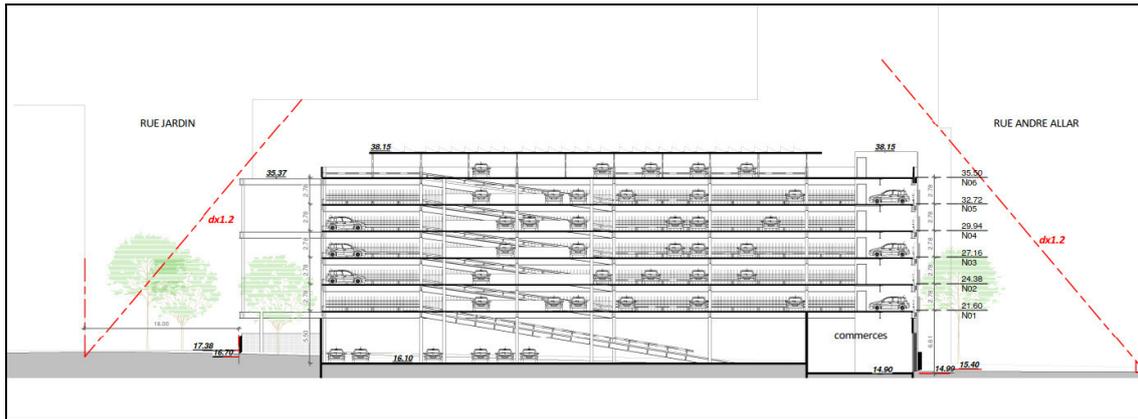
Coupe sur le parking silo (source : Linkcity, 2019)
